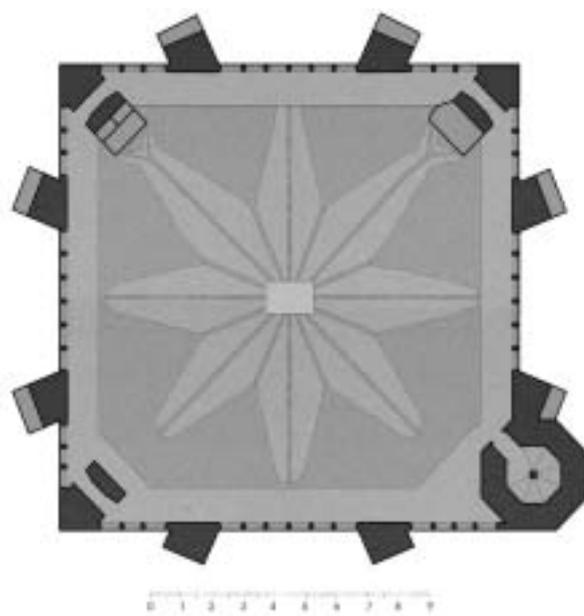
Para salvar el grueso del muro las saeteras se abren tras un lucillo cubierto con arco rebajado.
